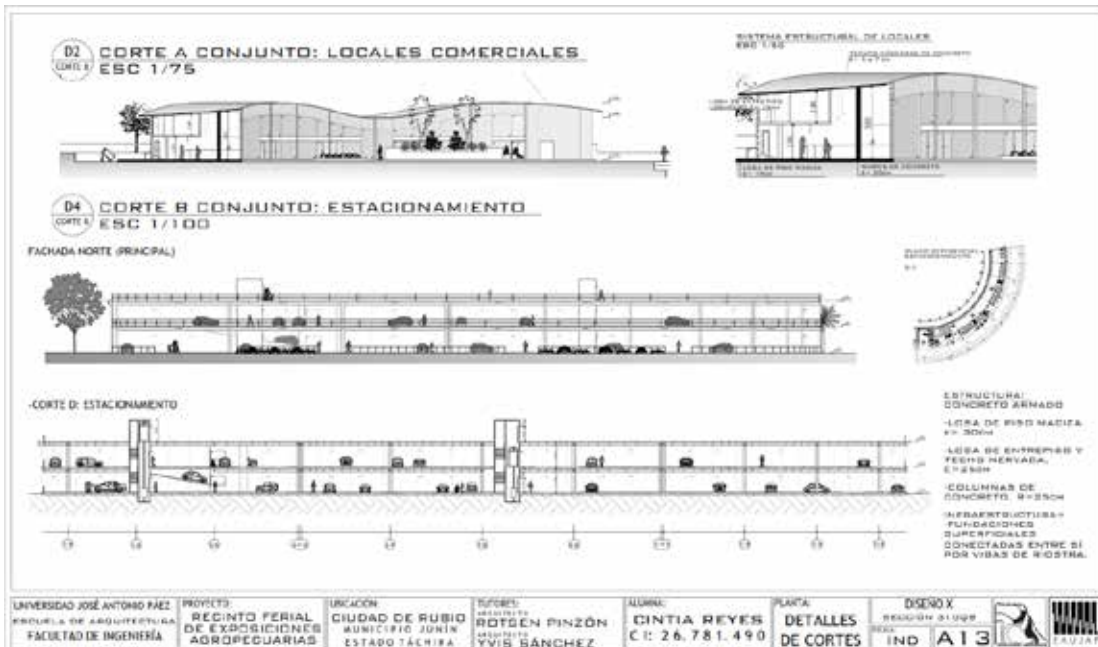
Plano A13, Detalle de cortes. La Autora (2020).
